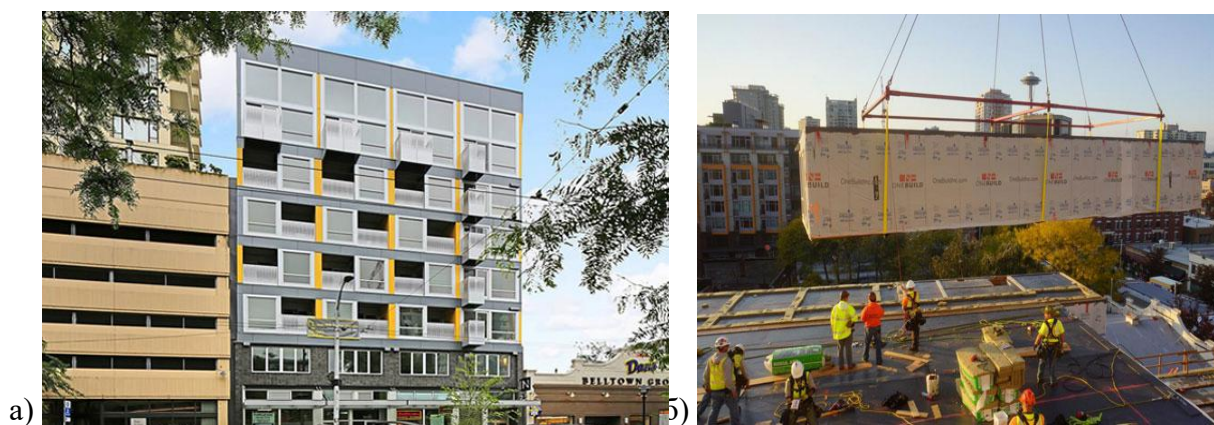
Жилой дом N'Habit: Belltown, Сиэтл, США: а – фото в настоящее время; б - строительная площадка компании One Build
